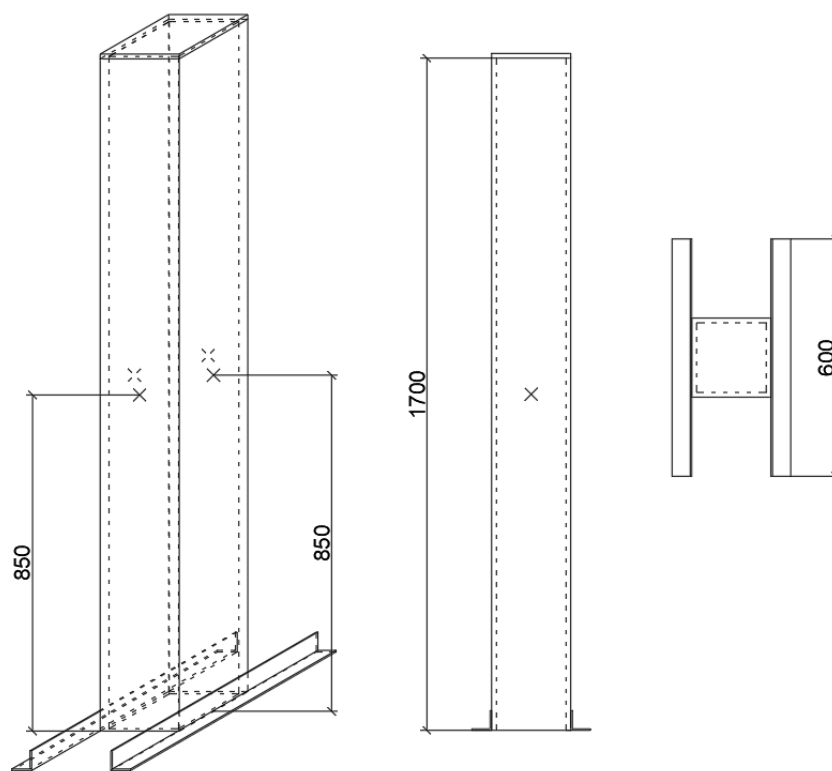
Схема модельной конструкции для проведения испытаний
